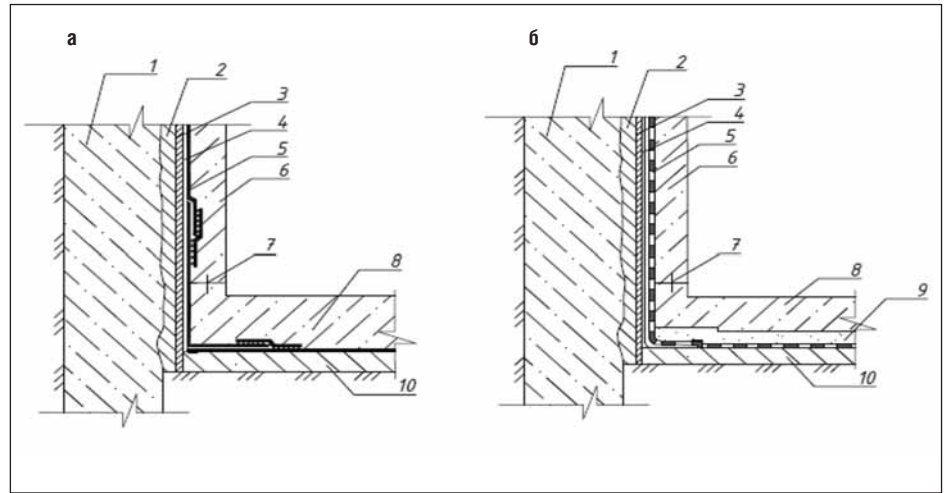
Гидроизоляция конструкций без пазух для обратной засыпки грунта: а – с применением мембран заводского изготовления; б – с применением листовой гидроизоляции с поверхностным слоем из напыляемых составов с двухсторонней адгезией; 1 – ограждающая «стена в грунте»; 2 – выравнивающий слой из мелкозернистого бетона или фальшстена; 3 – слой из геотекстильной ткани, ППС плит или профилированных мембран; 4 – плоскость скольжения; 5 – гидроизоляционное покрытие; 6 – постоянная стена; 7 – гидрошпонка; 8 – лотковая плита; 9 – защитный слой из мелкозернистого бетона; 10 – бетонная подготовка
